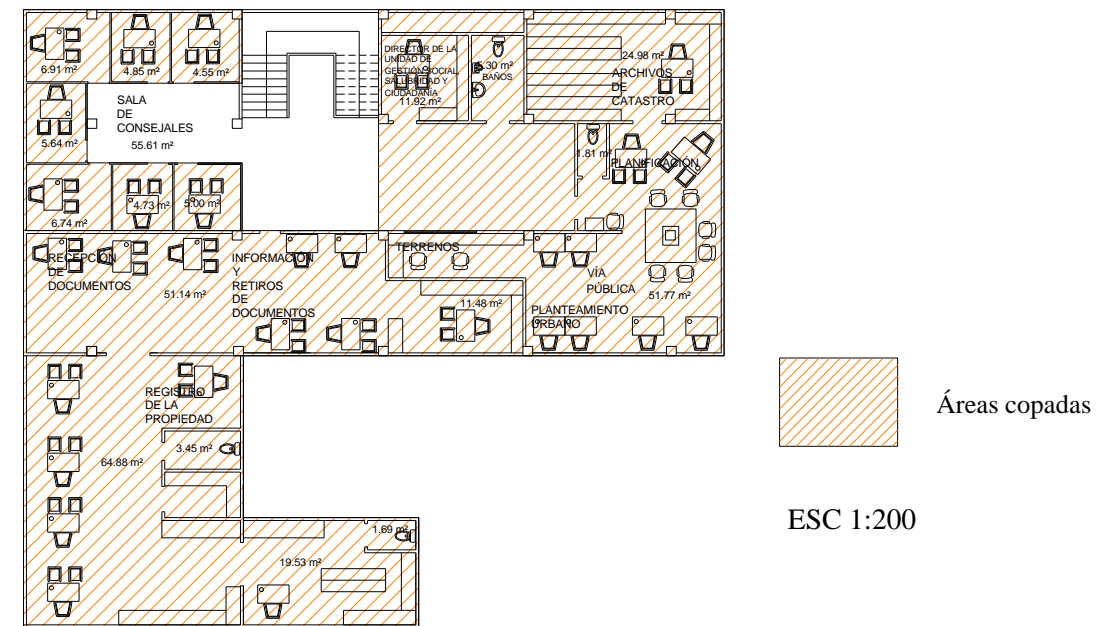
Primera Planta Alta. Municipio Actual de Playas.
